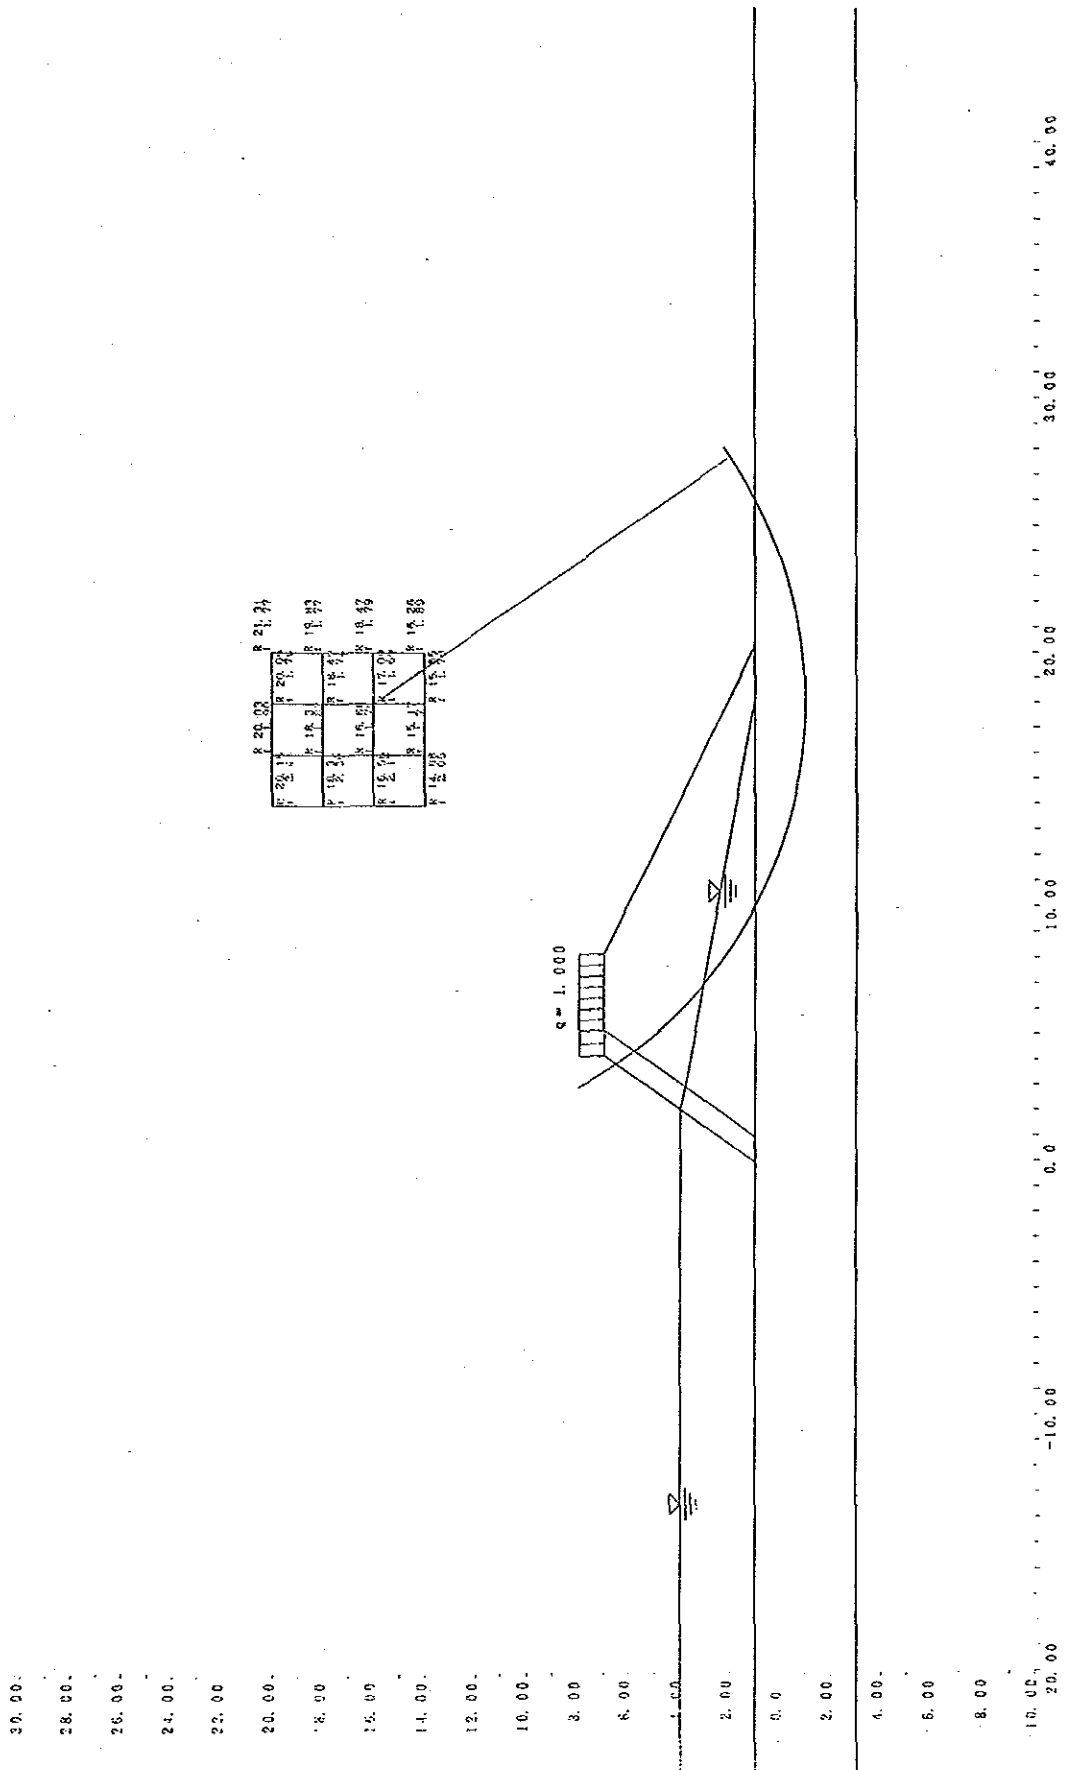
钦江河川堤防上流侧斜面安定计算
